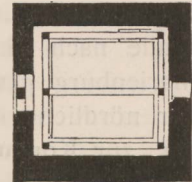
Grundriß des mittleren Turmgewölbes zu Abb. 59. Maßstab 1 : 400.
